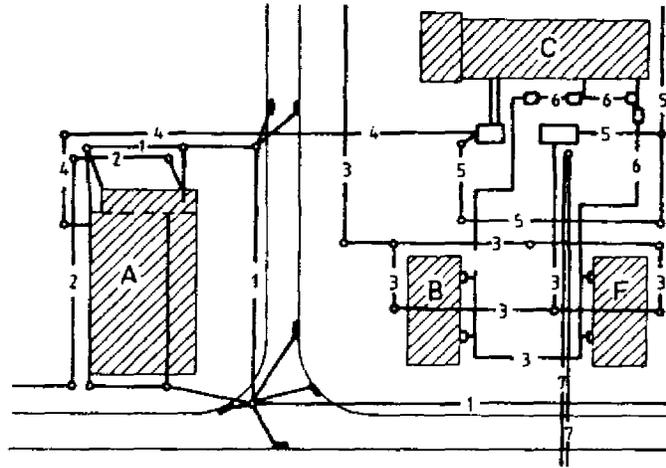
2: Diagrama de los sistemas de alcantarillado en una planta química /26/
